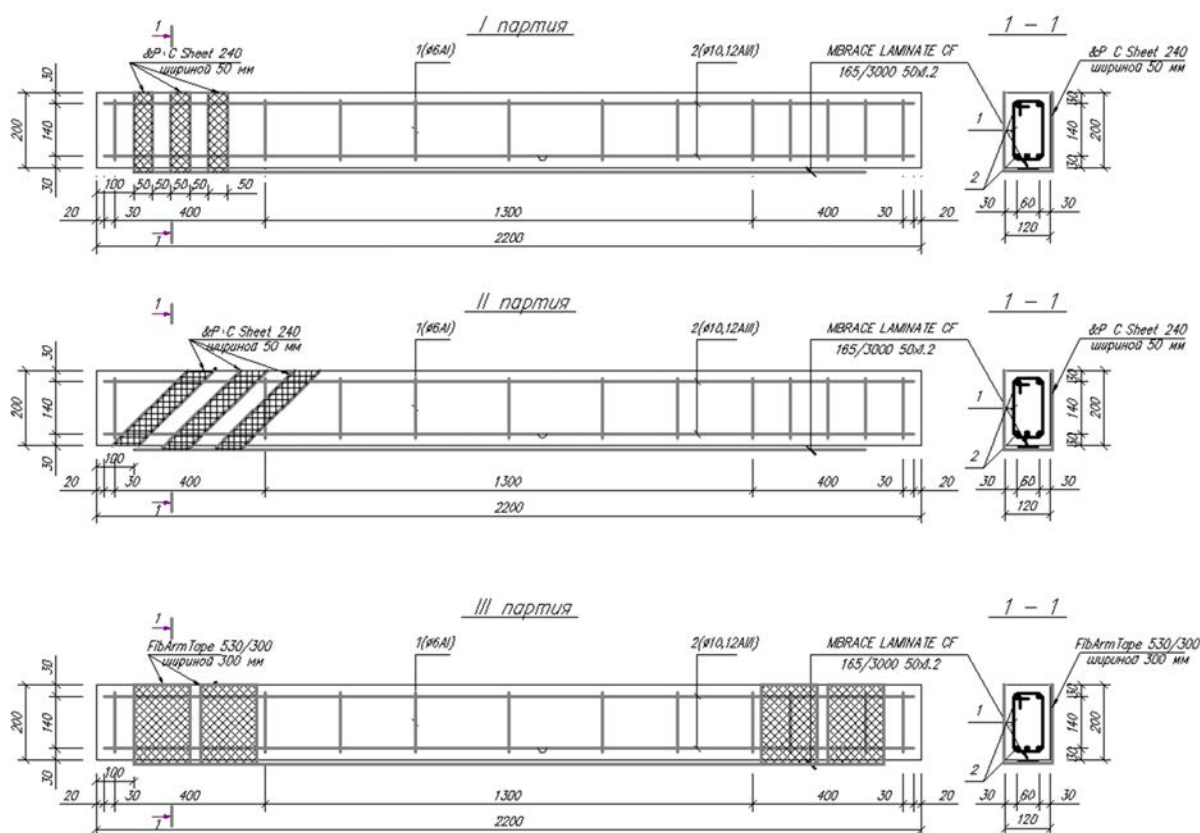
Усиление наклонных сечение изгибаемых железобетонных балок вертикальными и наклонными полосами фибрармированными сетками
